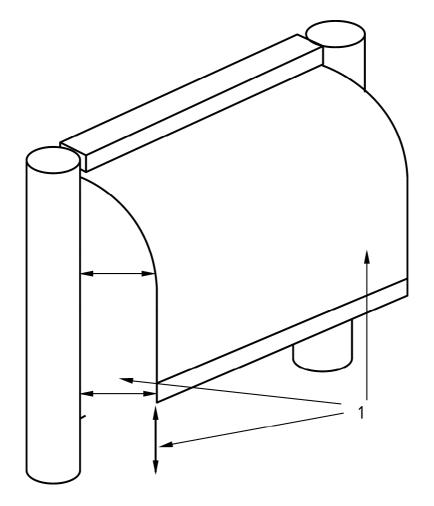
toont een lichtgewicht rookscherm dat aangrenzend aan kolommen is ingebouwd. Wanneer dit scherm niet geleid wordt, kunnen grote zijspleten en horizontale spleten door opdrijving ontstaan.
